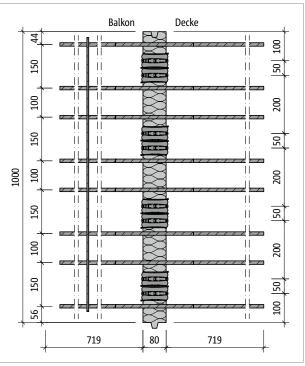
Schöck Isokorb® T Typ QL-V1: Produktgrundriss
